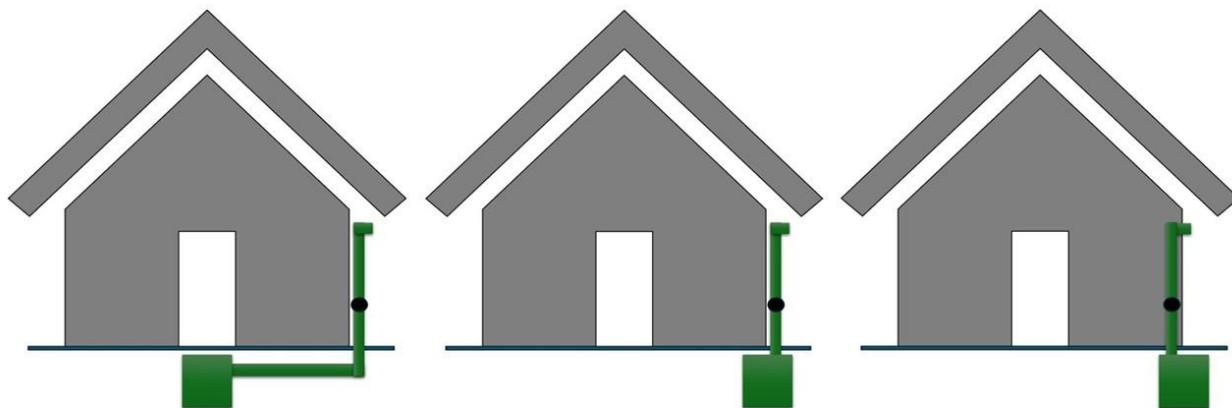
Esempi di mitigazione attiva del gas radon tramite pozzetto centrale o perimetrale (interno ed esterno)
